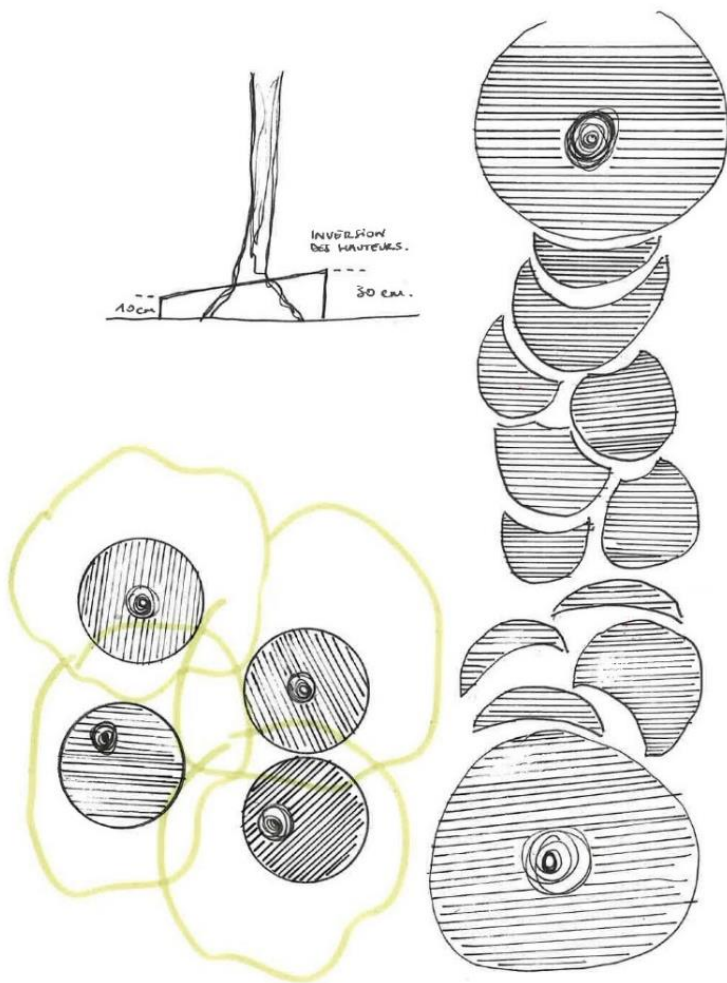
Croquis plateforme en bois vue plan et vue en coupe
